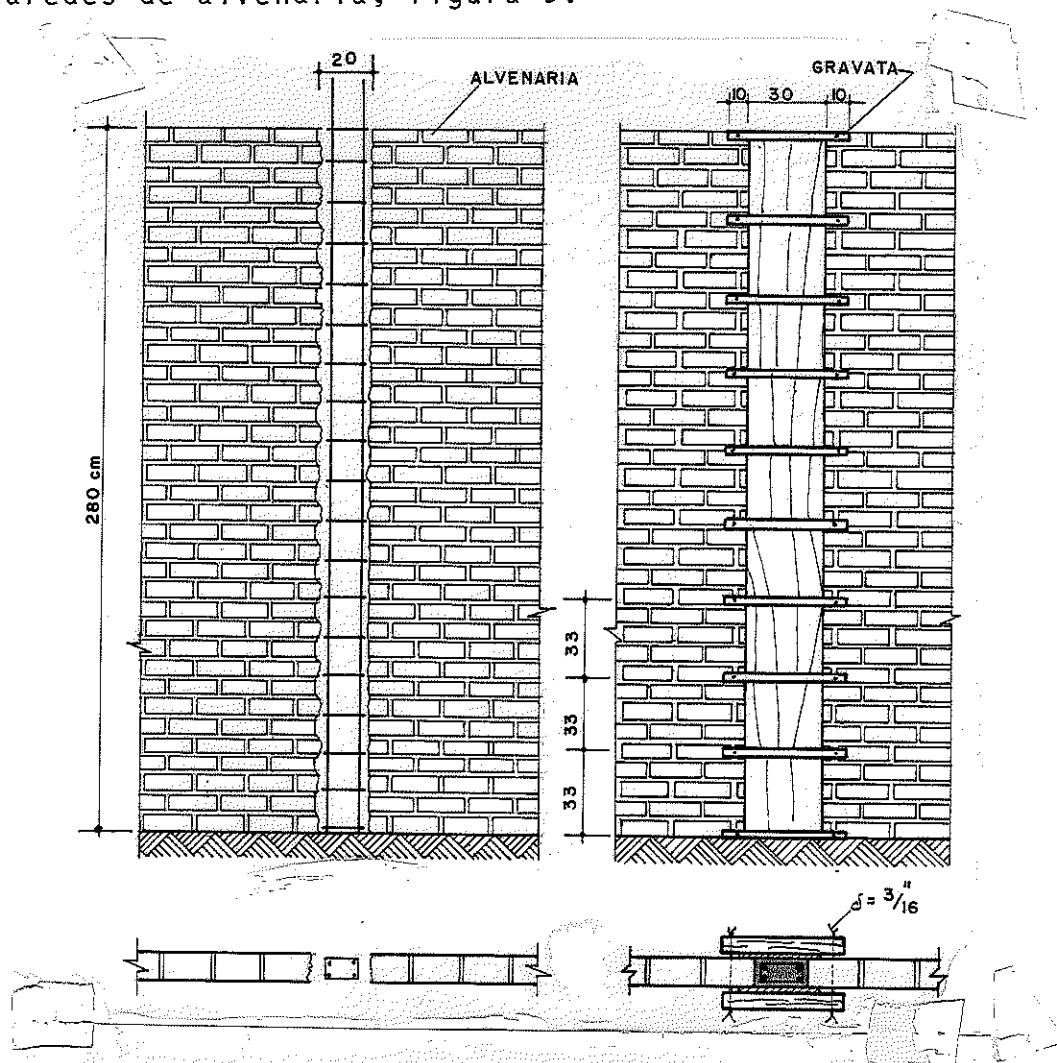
ESQUEMA DE CONCRETAGEM DE UM PILAR DE CONCRETO NA PAREDE DE ALVENARIA
